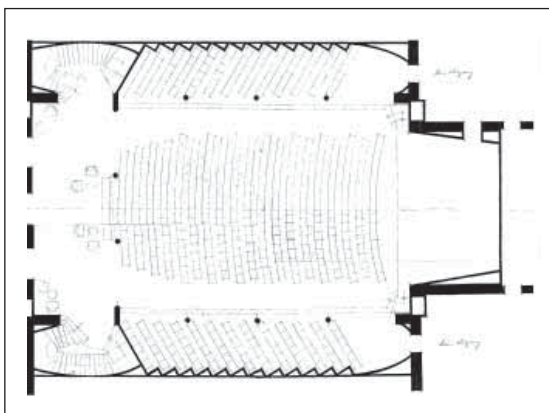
Laeiszhalle, Kleiner Saal, Grundriss, Umbauentwurf von B. Mundt vom November 1952
